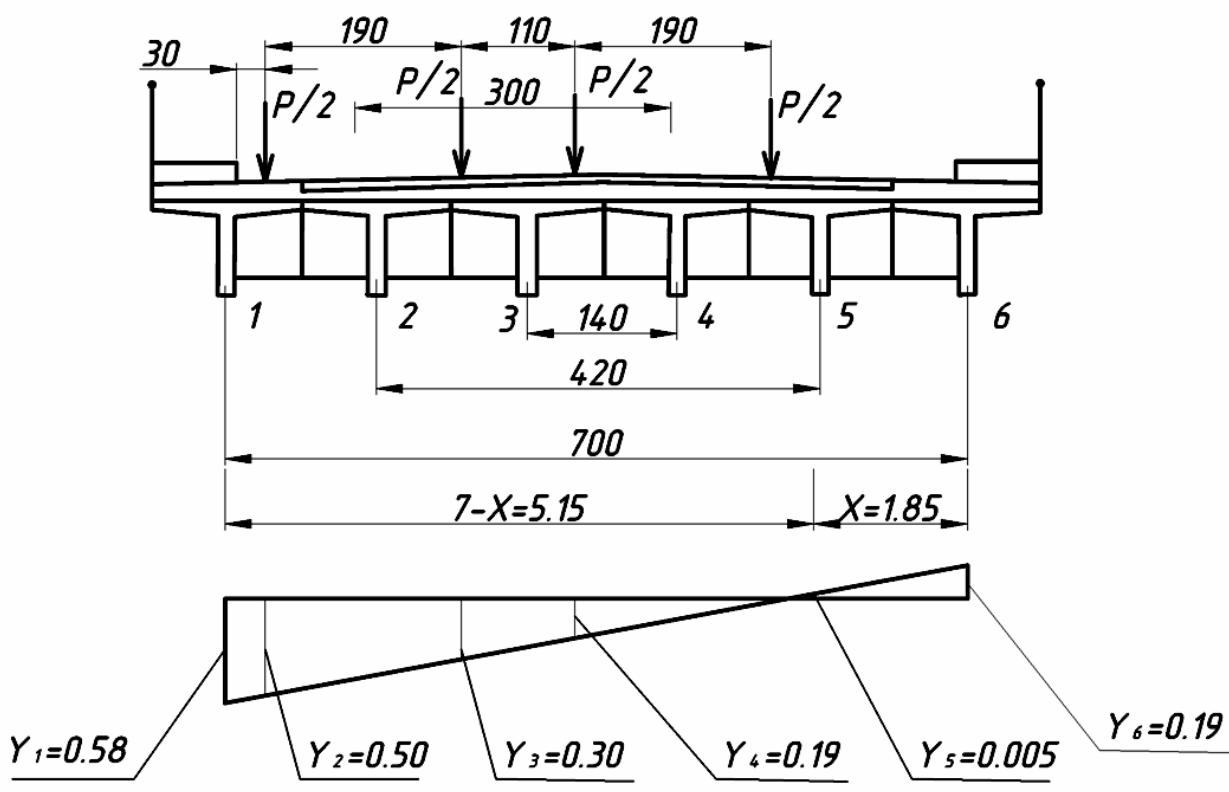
Схема к определению коэффициента поперечной установки от нагрузки А-11
